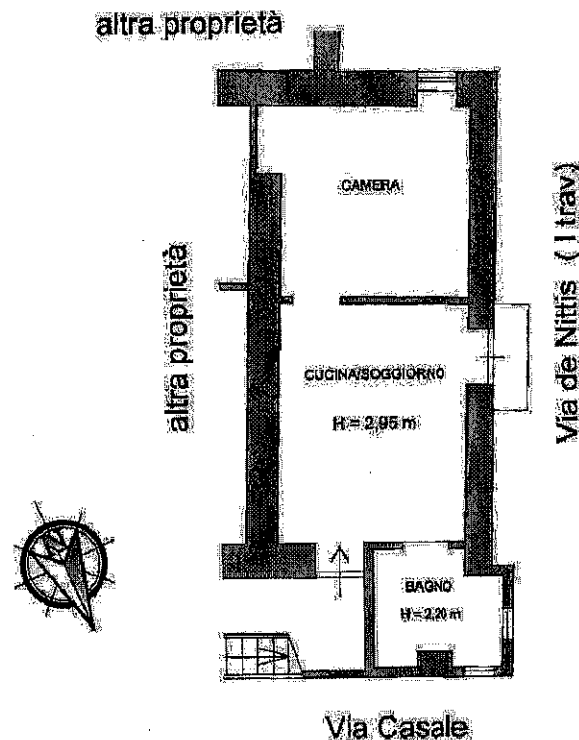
LOTTO 1 - planimetria appartamento al piano terra
